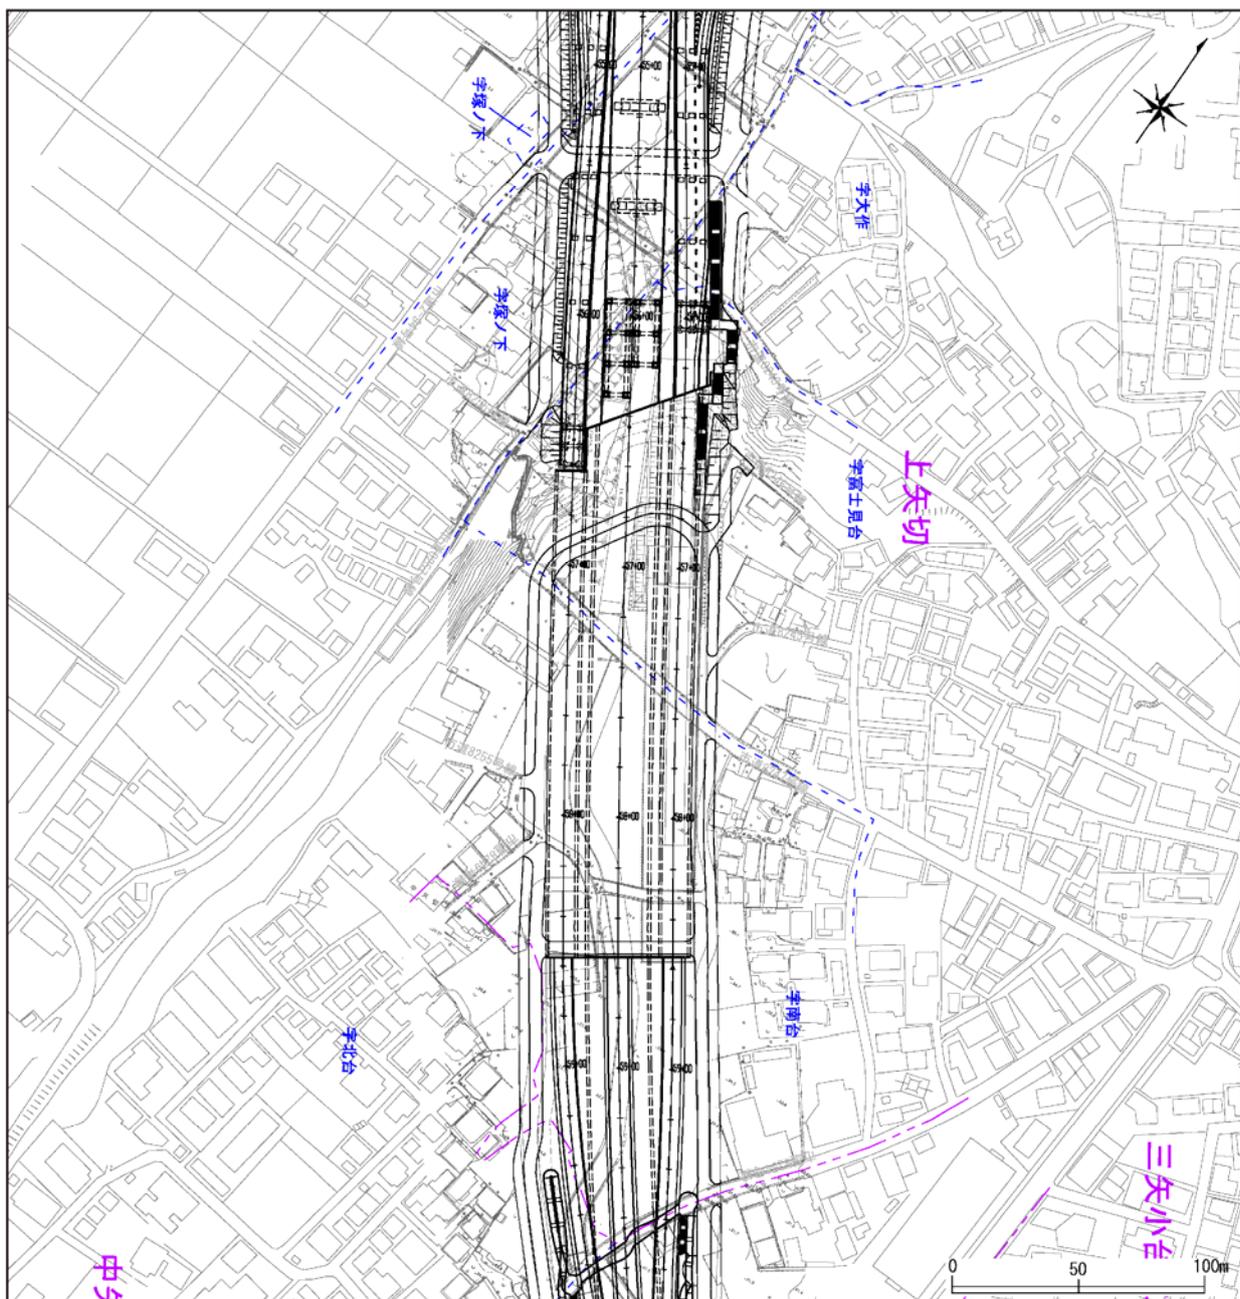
(16) 特殊部予測平面图 (矢切蓋掛区間)
